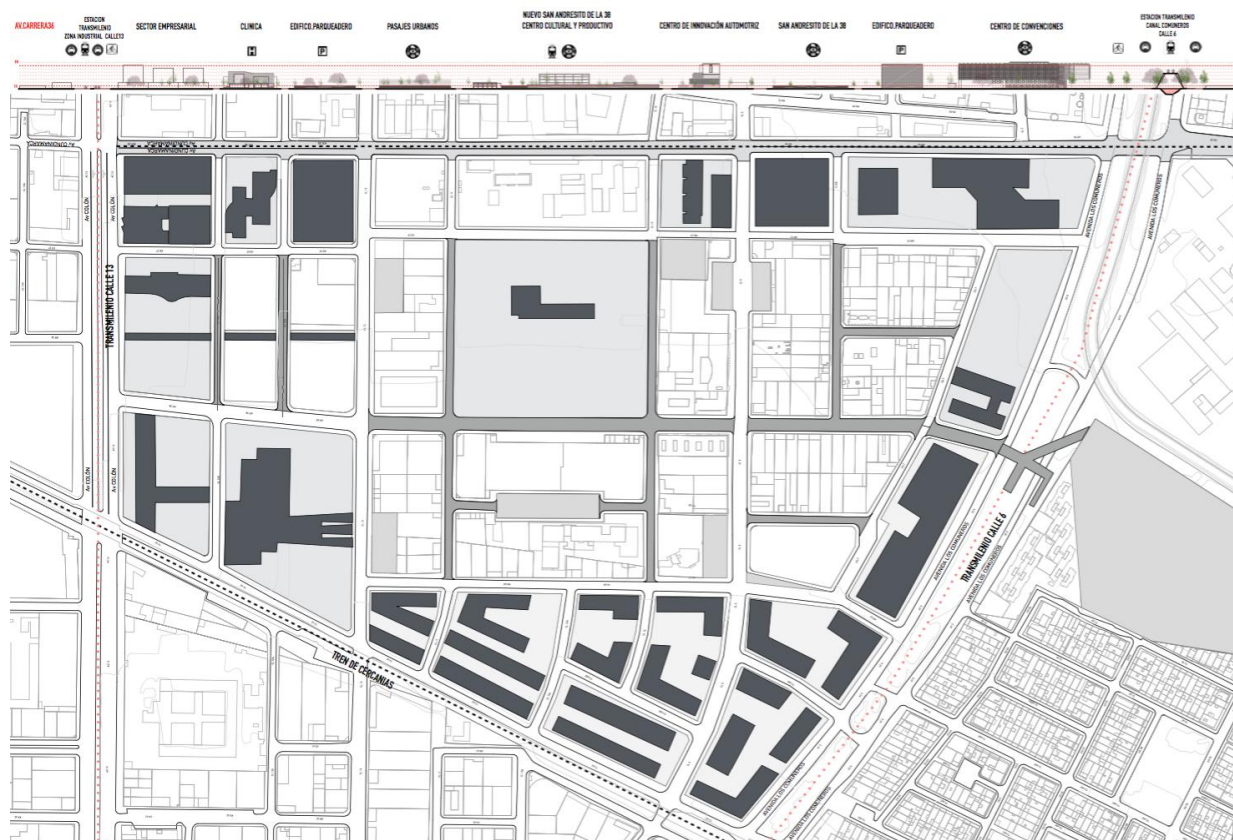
Plano de propuesta de masas en el tratamiento de borde
